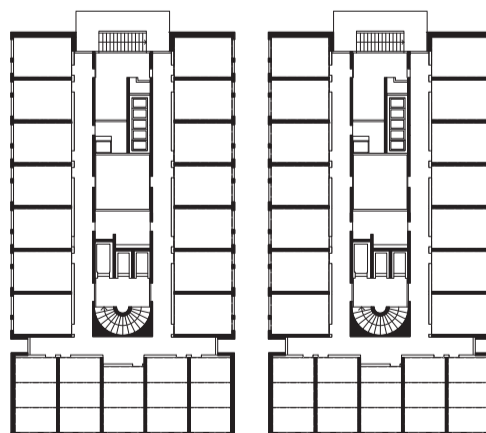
Links: Grundriss Nachtetage; rechts: Grundriss Tagetage.
